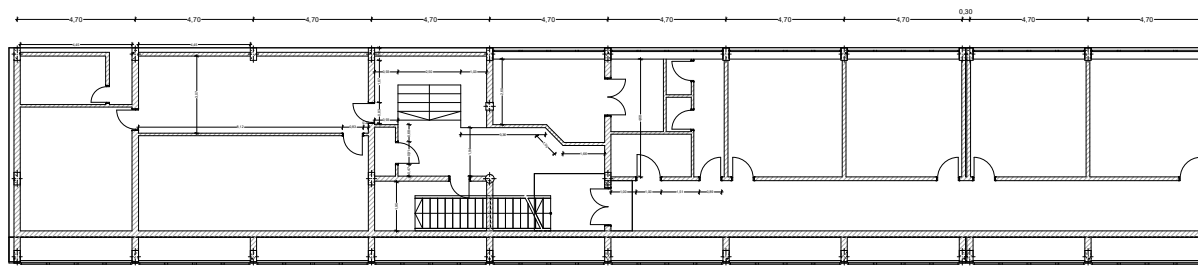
Università di Architettura e Urbanistica UAUIM "Ion Mincu" - Pianta piano terra
